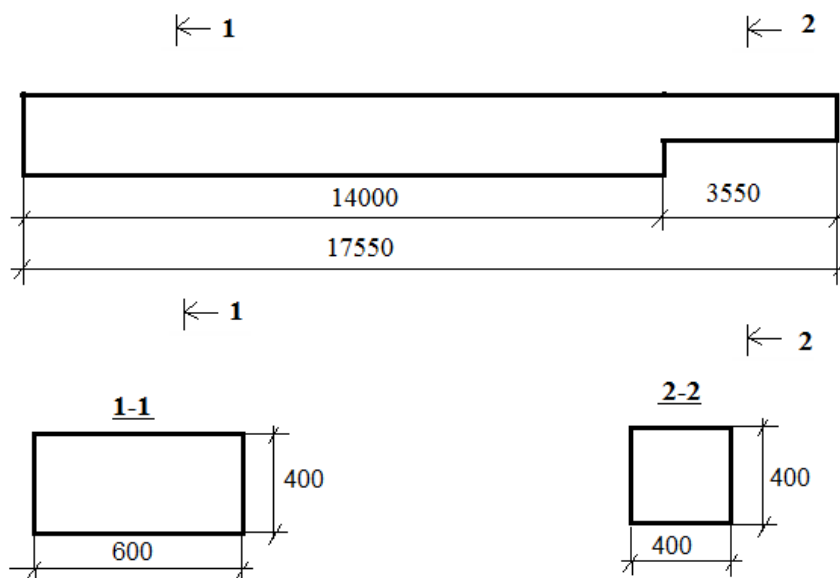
Залізобетонна колона крайніх рядів
